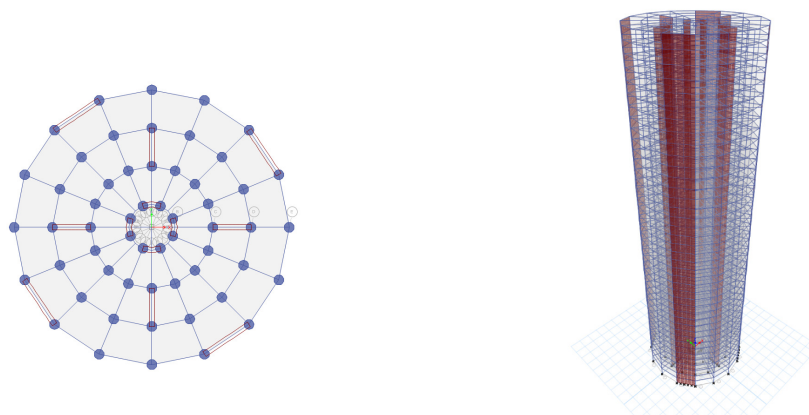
Structura duala din b.a. avand forma circulara - plan si elevatie
